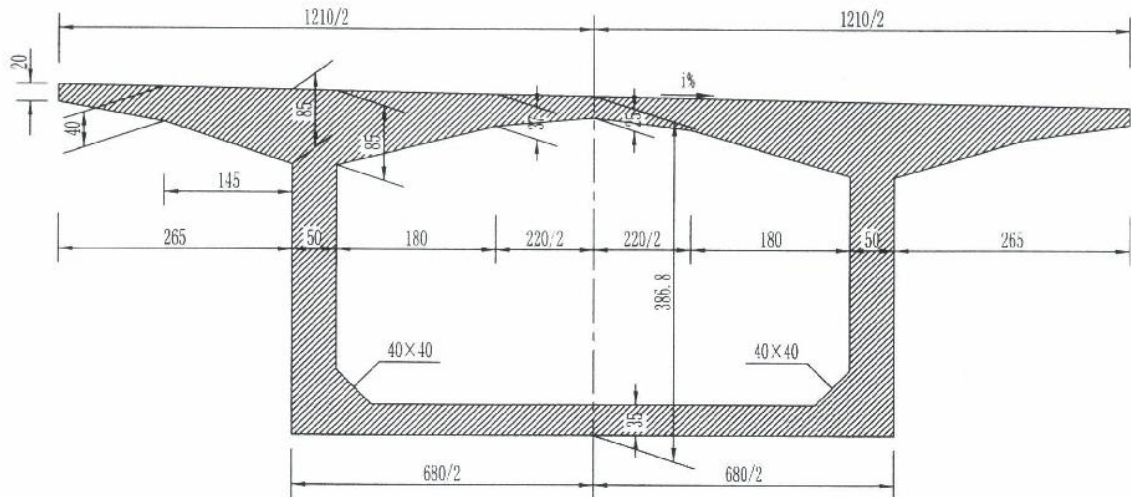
黑石沟特大桥主桥单幅典型横断面布置示意图 (尺寸单位为 cm)
